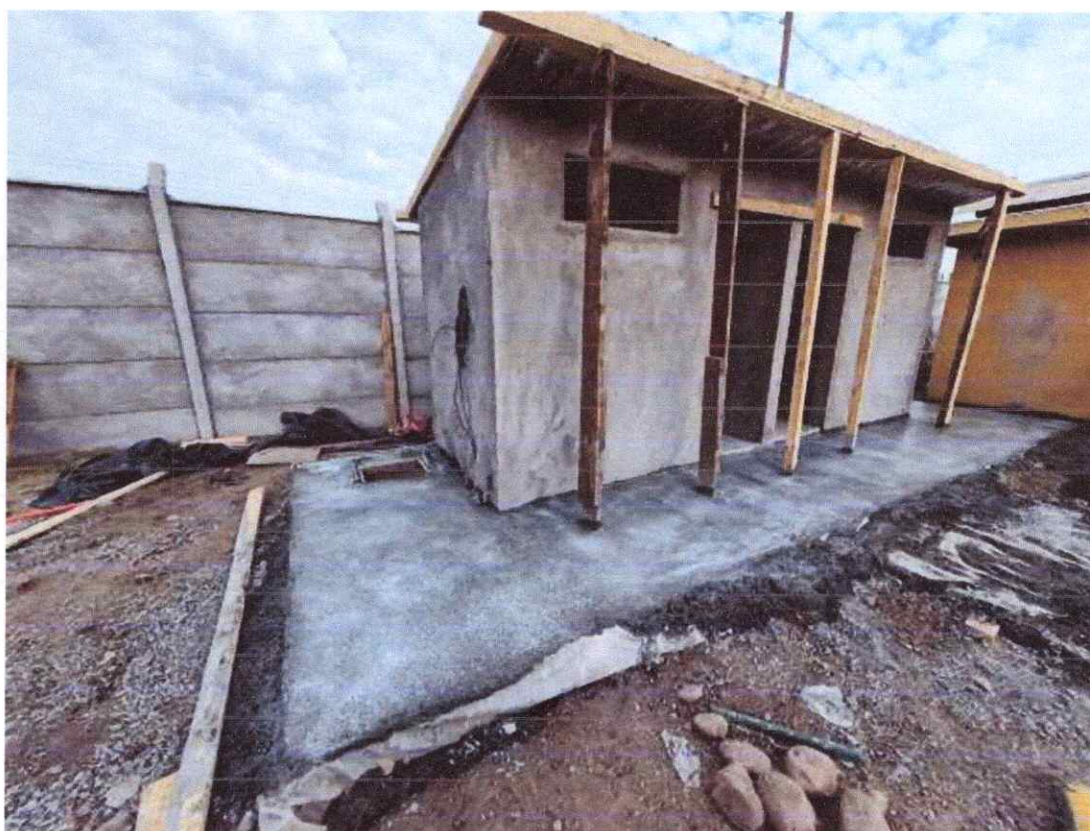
ITEM 2.2 RADIER Y ZOCALO DE HORMIGON.
